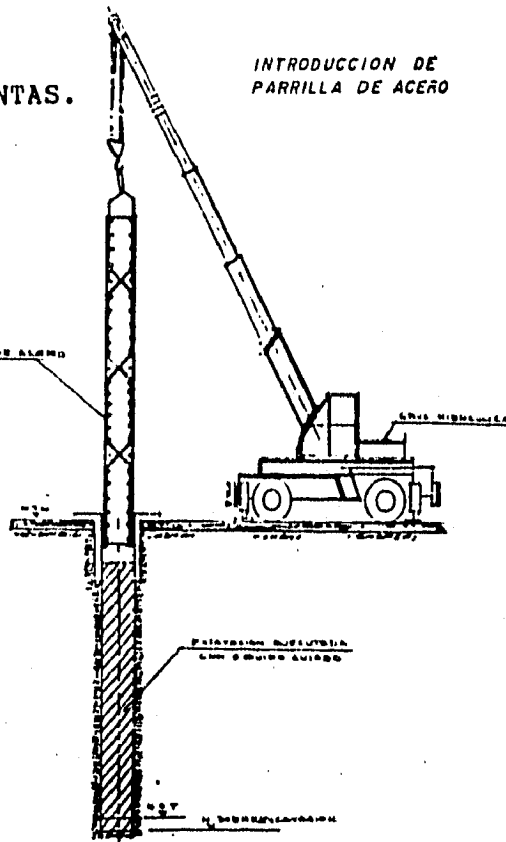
MANIOBRA DE LANZADO DEL ARMADO.
